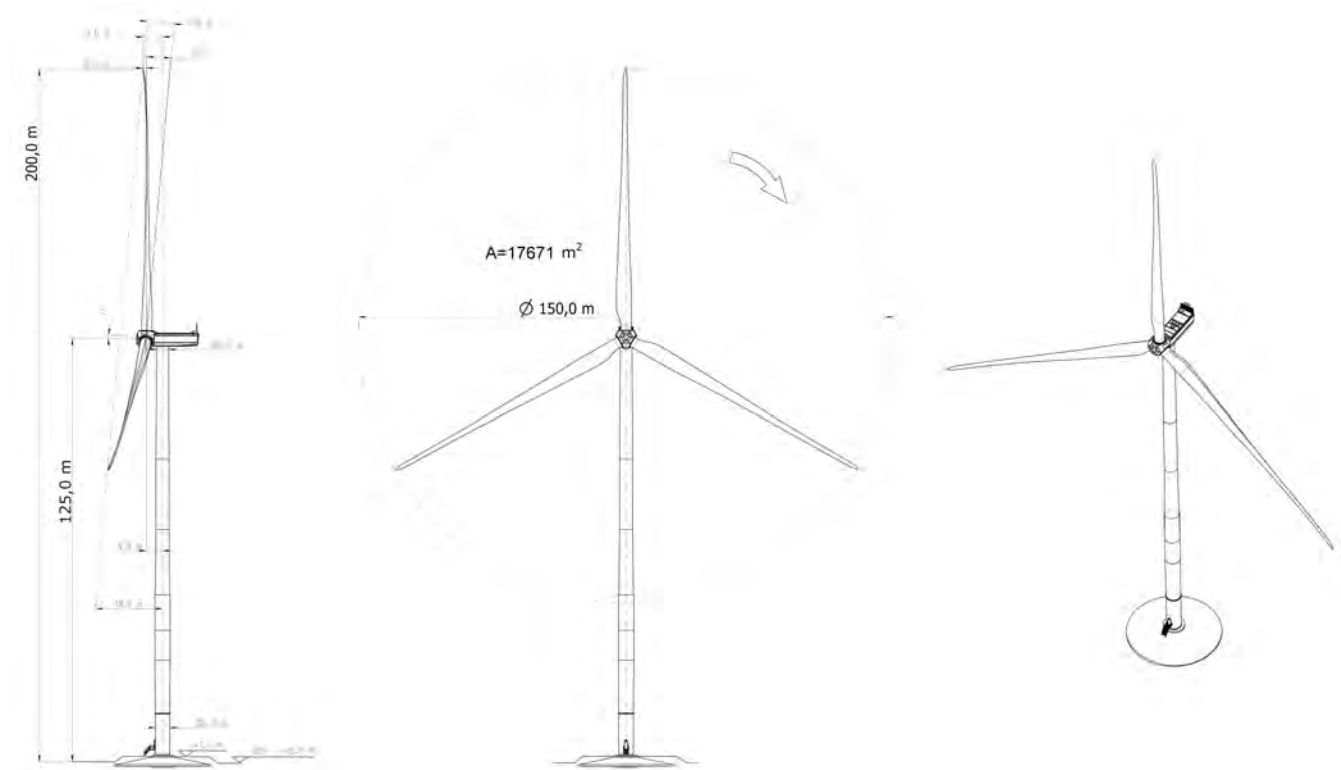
Exemple de plans d'une éolienne-type et dimensions
